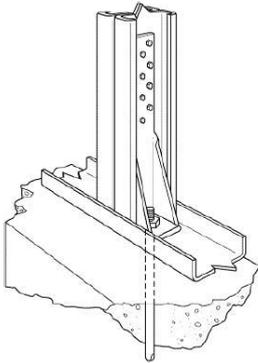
Desenho Arquitetônico Estrutura Metálica
